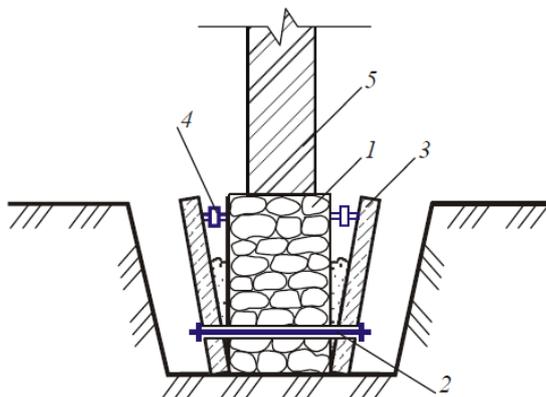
Увеличение площади опирания фундаментов с помощью железобетонных отливов: 1- фундаментов; 2-стальной тяж; 3-железобетонный отлив; 4-домкрат; 5-стена
